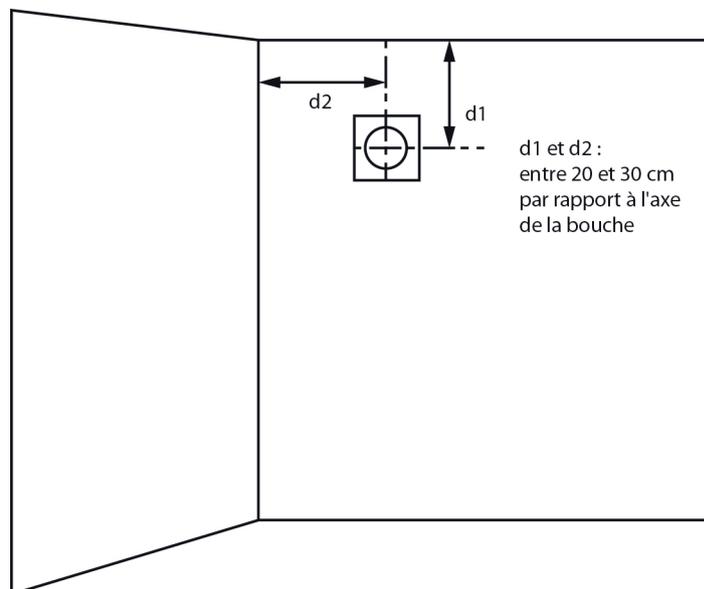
2 : Exemple d'installation d'une bouche de soufflage au plafond
